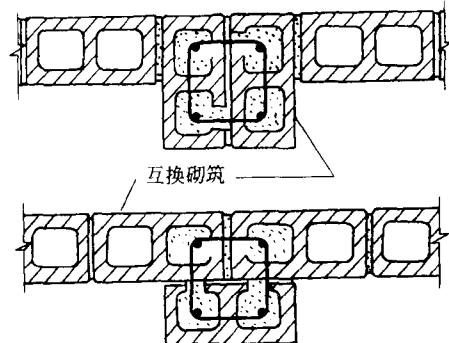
配筋混凝土空心砌块砌体(带壁柱墙)
